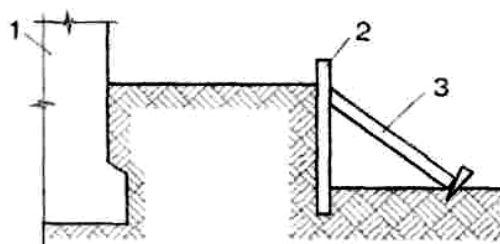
Схема підкосного кріплення: 1 – існуючі конструкції; 2 – захищаюча конструкція; 3 – підкошування
